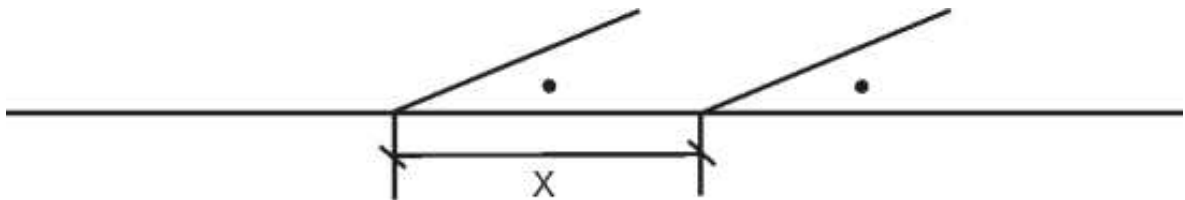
Схема взаимной укладки стрелочных переводов
